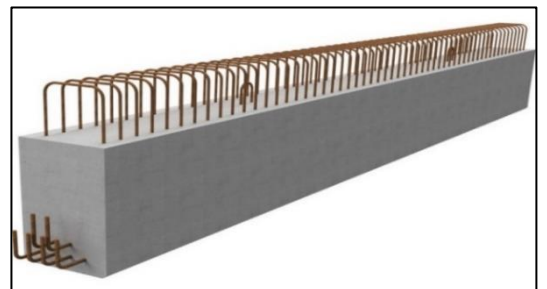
Poutres préfabriquées en béton (source : <https://www.rector.fr/produits/poutres-de->
